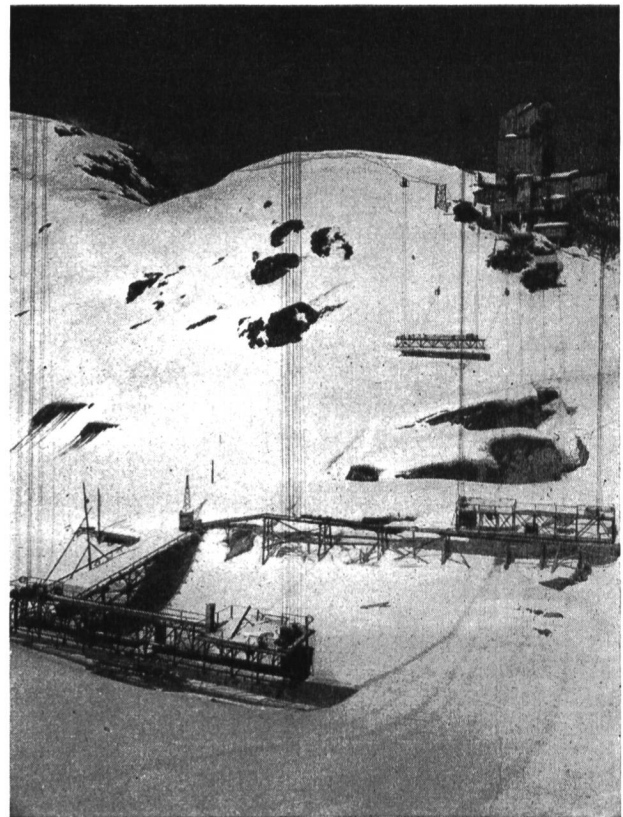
Kraftwerk Lucendro. Baustelle der Mauer im Frühjahr 1944 vor Wiederaufnahme der Bauarbeiten. Rechts oben die Betonfabrik, links unten die eine Betonierbühne fertig montiert und an den Seilen hängend, in Bildmitte rechts die zweite Betonierbühne auf dem Montagegerüst, darüber im Bild die Schalbühne. Aufnahme vom 4. April 1944.
